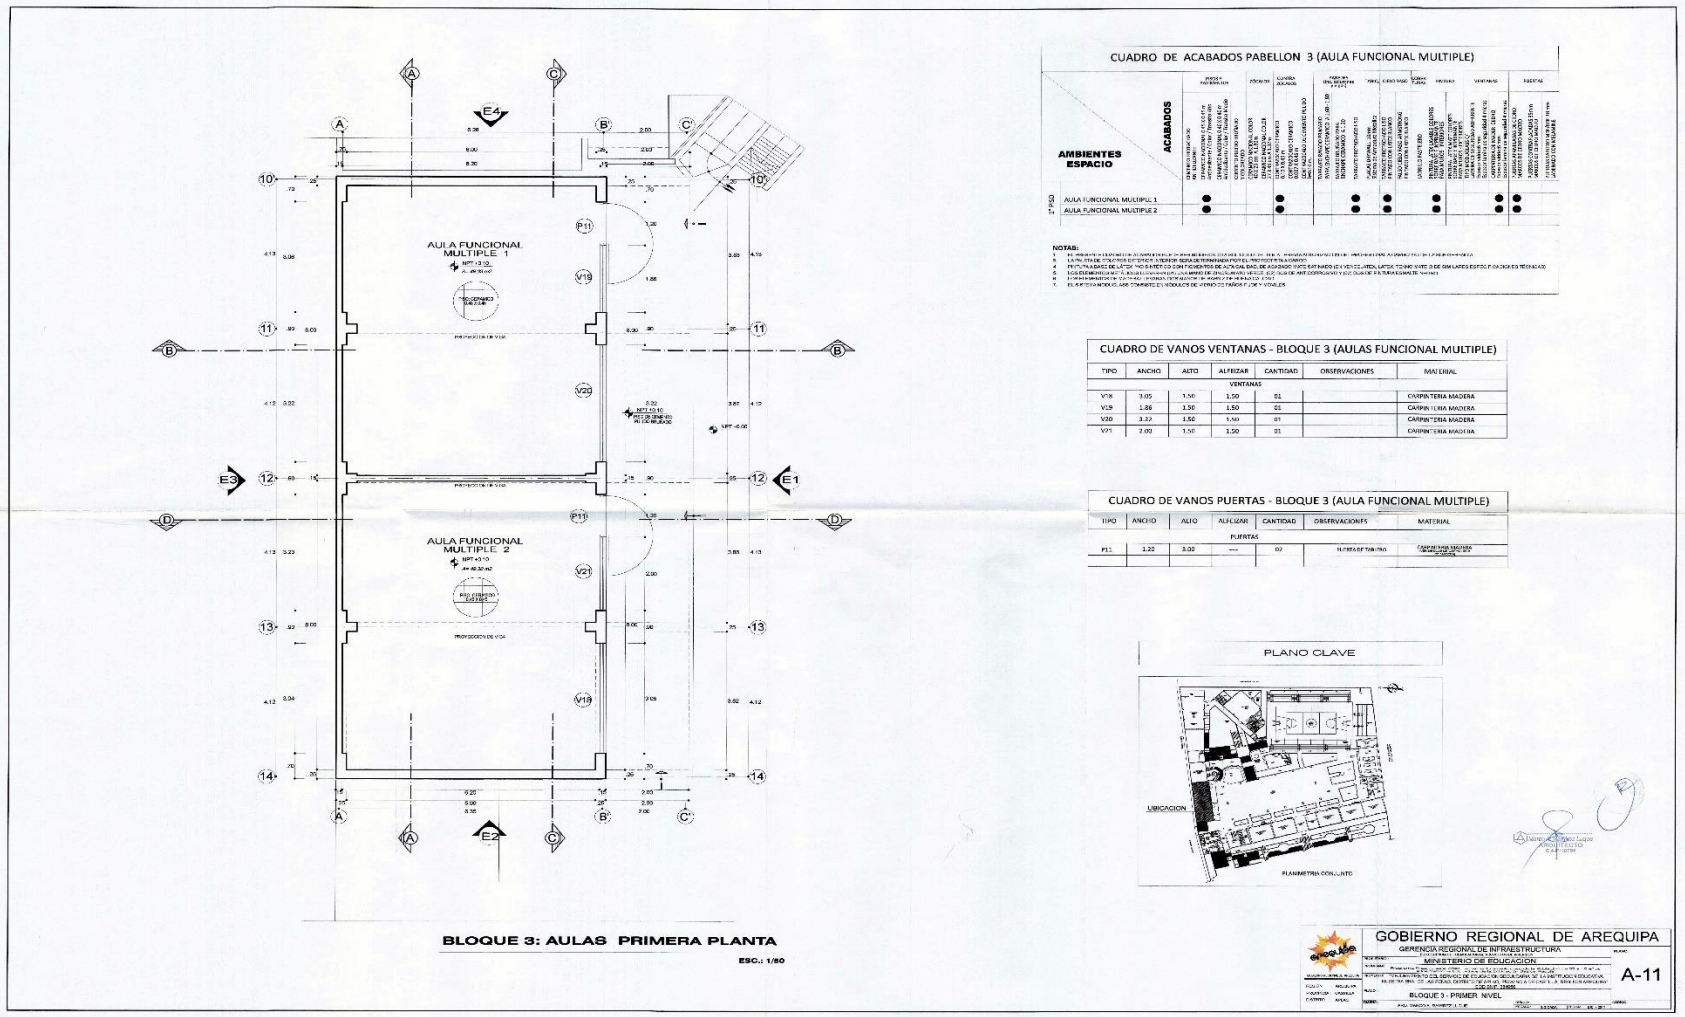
Plano de arquitectura – Planta del bloque 03 aulas función múltiple.
